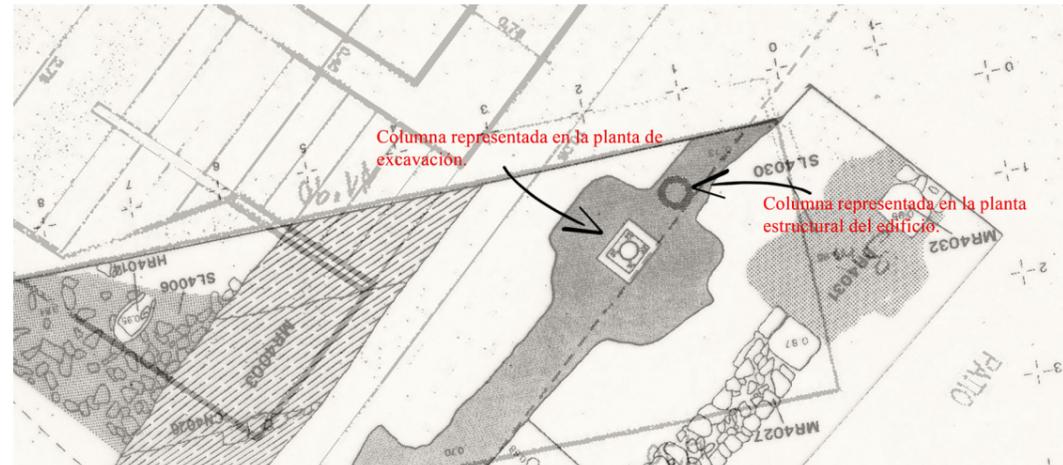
Combinación de la planimetría de la excavación con la planimetría estructural del edificio.
